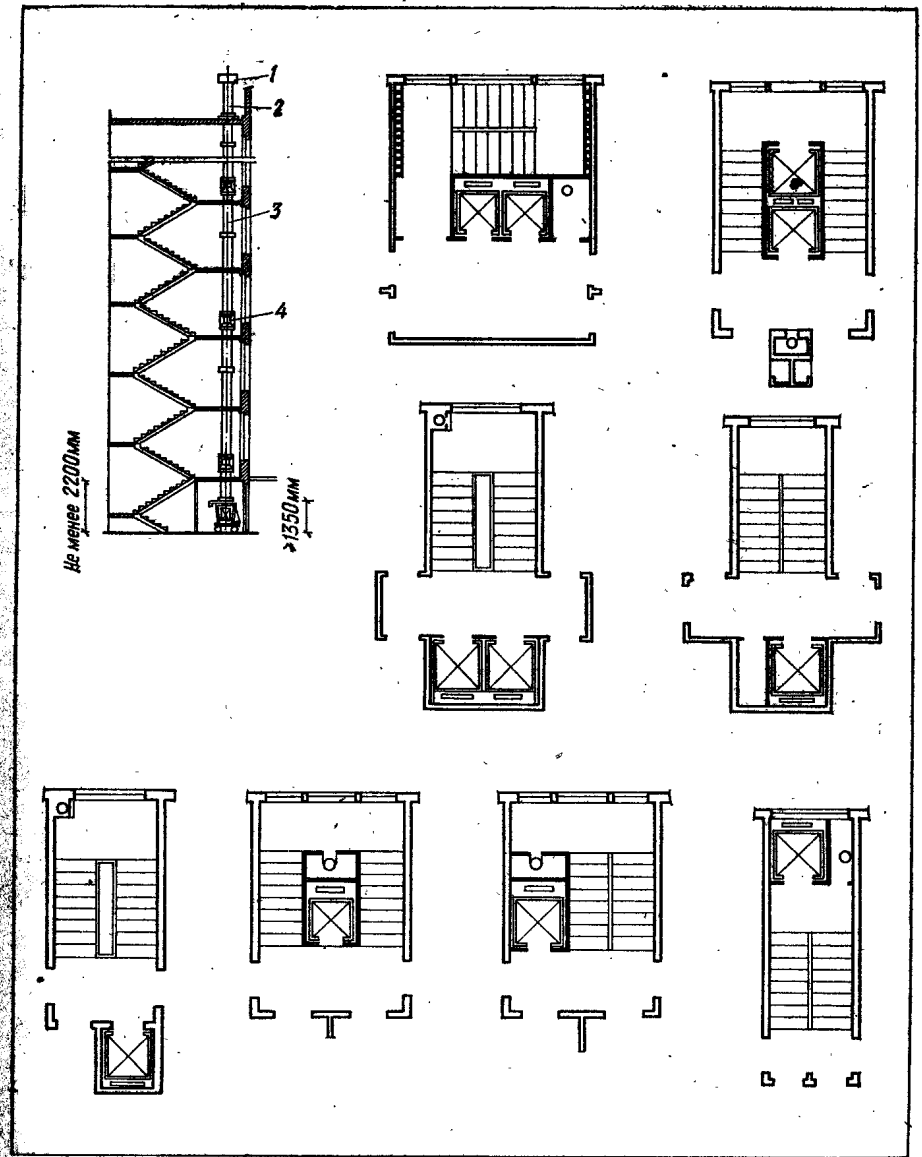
Схемы установки мусоропроводов и лифтов в лестничных клетках жилых зданий.
